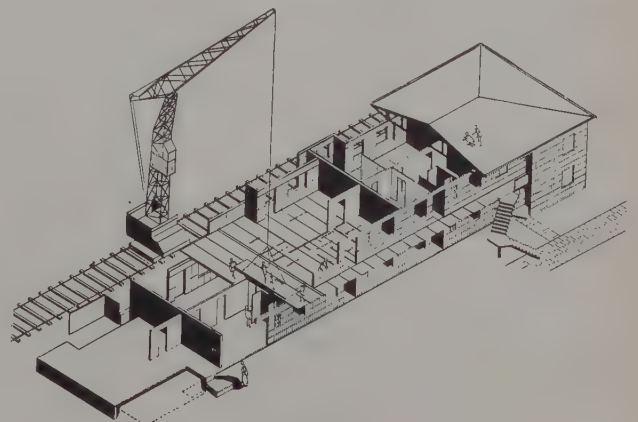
Zweigeschossige Wohnhäuser in Hvidovre (Vorort von Kopenhagen). Außenwandblöcke Leichtbeton 59 x 109 x 23 cm mit 3 cm Betonvorsatz als Außenhaut, durch Fugen architektonisch unterteilt, Gewicht 135 kg. Deckenelemente 110 cm breit, 408 und 540 cm lang. Fenstersturzelement durchgehend, schwerstes Bauelement 1,3 t
